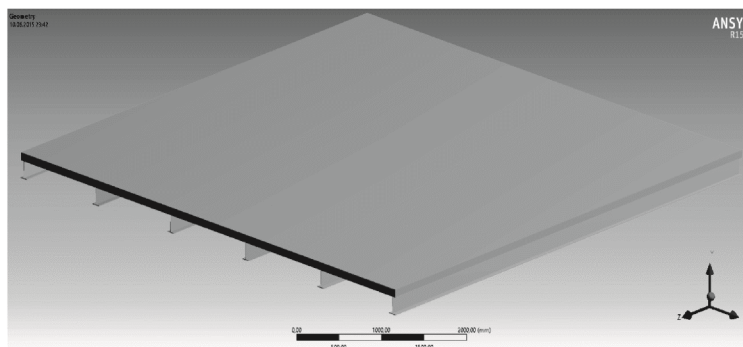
Модель сталежелезобетонной плиты с ребрами из прокатных двутавров
